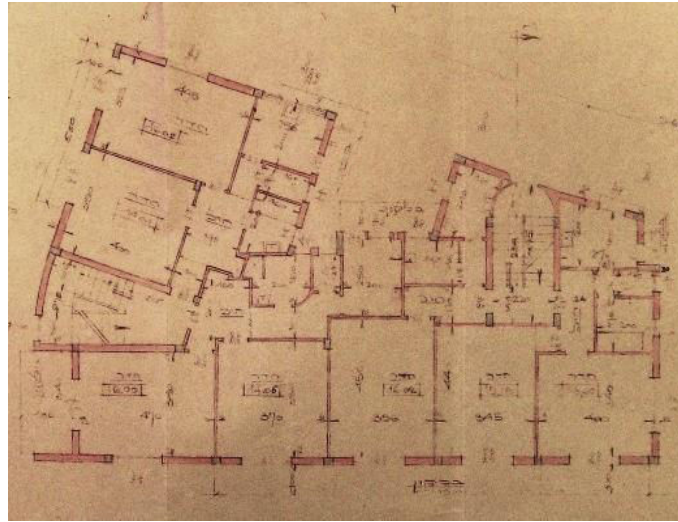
Le plan d'un étage typique, construction dans le style international, 1 rue Aharonovitch, janvier 1939.
